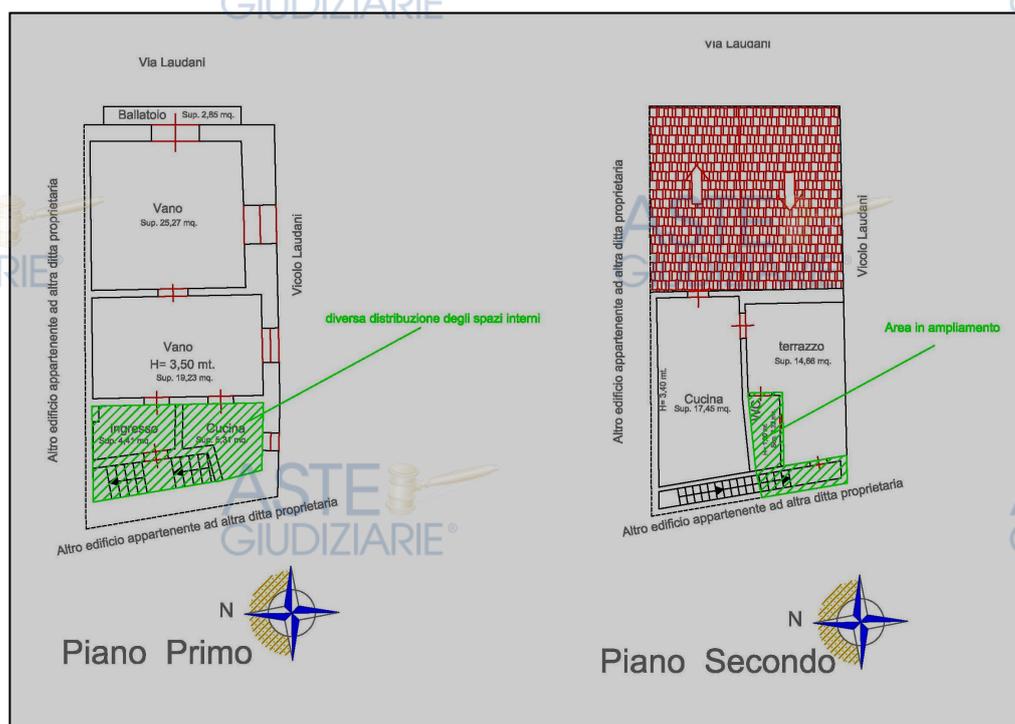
Visualizzazione della pianta planimetrica dell'immobile a piano primo e secondo con indicazione delle difformità riscontrate
